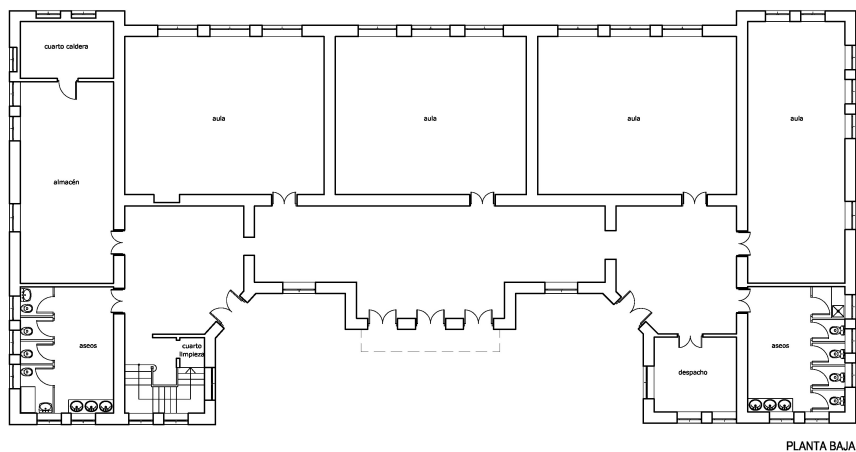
Plano de Planta Baja del C.E.I.P. Fabián y Fuero (Fuente: Elaboración propia).
